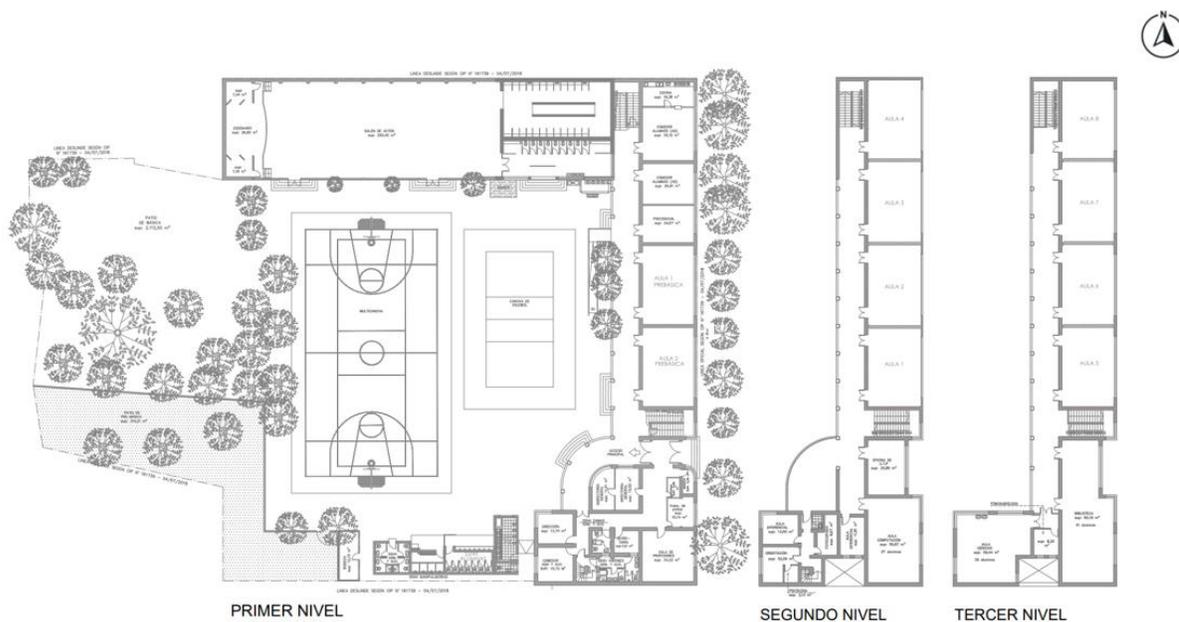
Planos en planta de la escuela, 1, 2 y 3 nivel.
